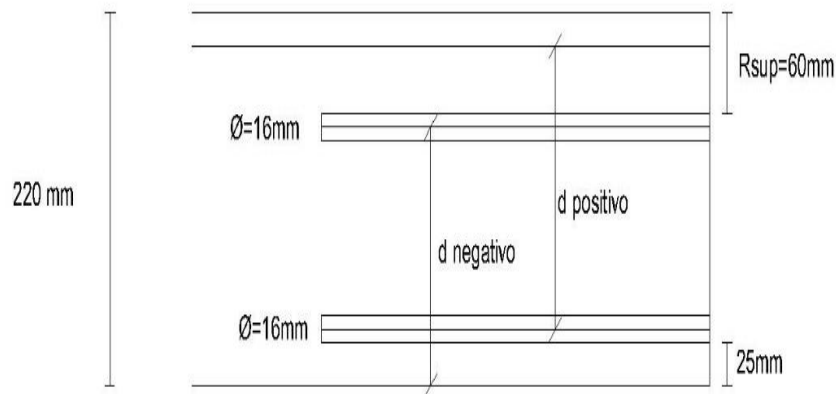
22: Alturas efectivas para el armado del tablero (Fuente: Elaboración Propia)
